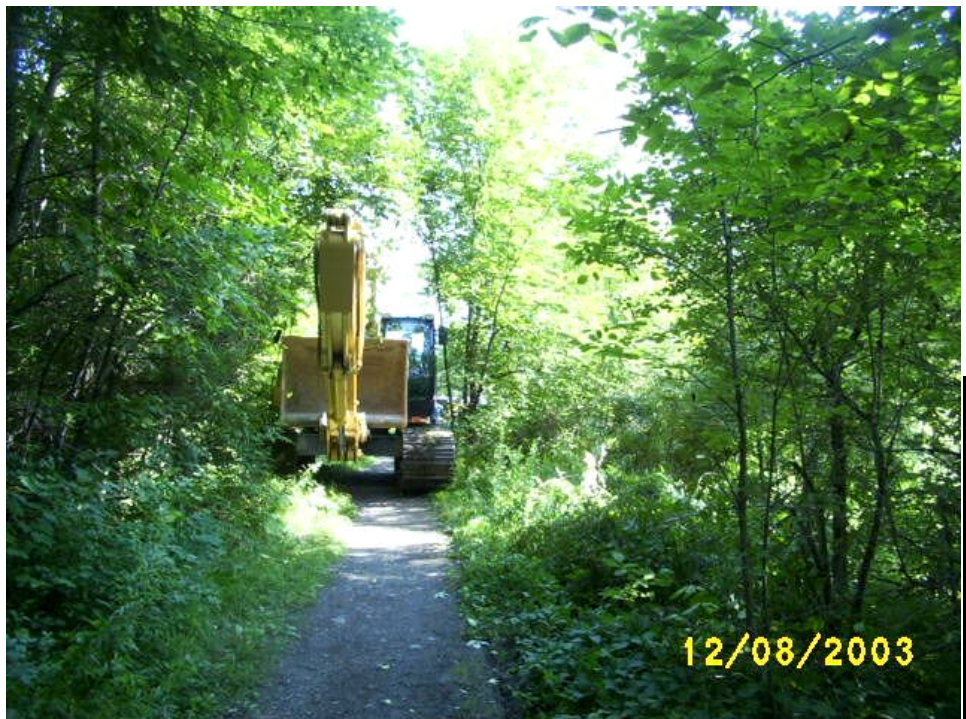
Accès au site des travaux via le sentier Robert (Chemin # 2)
